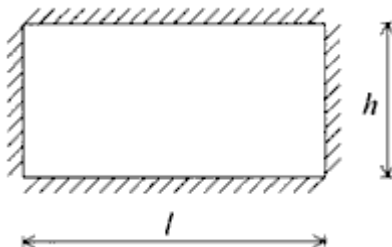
Стена, защемленная на уровне верхнего и нижнего перекрытий и по двум вертикальным сторонам
